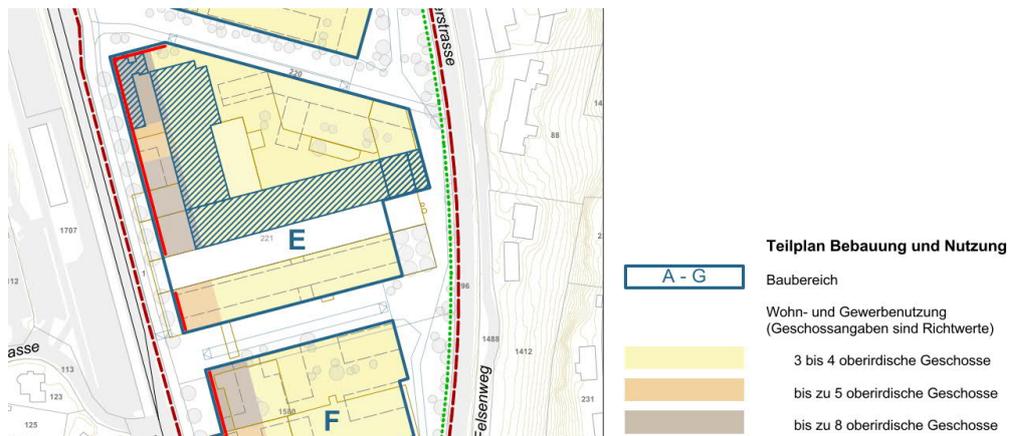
Ausschnitt Teilplan «Bebauung und Nutzung» ERP, Lage und Verteilung der Gebäude bis zu 5 bzw. 8 Vollgeschossen
